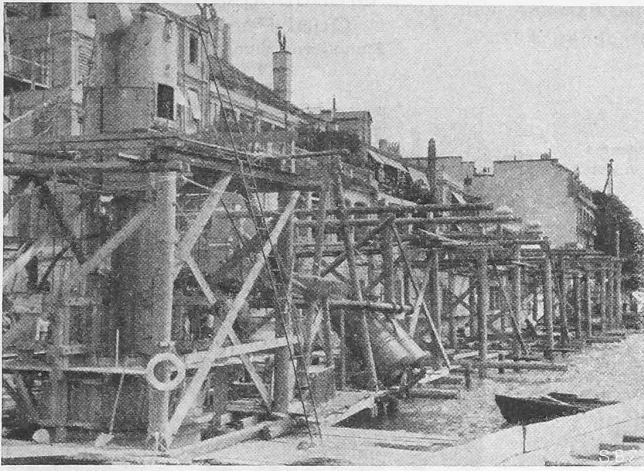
Versenken der innern Caissons ab festem Gerüst.
